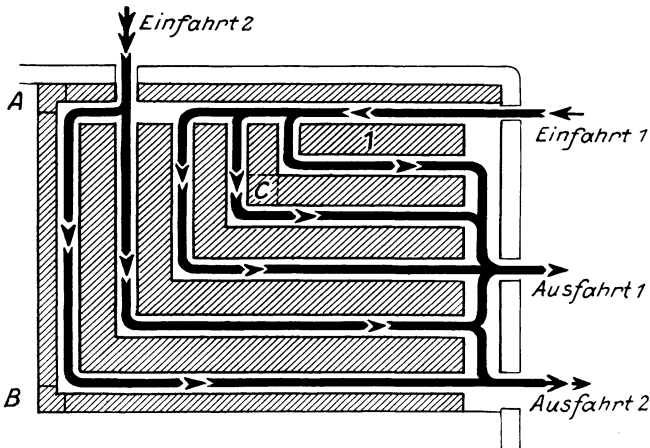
Garagenflachbauten mit rechteckigem Grundriß.
